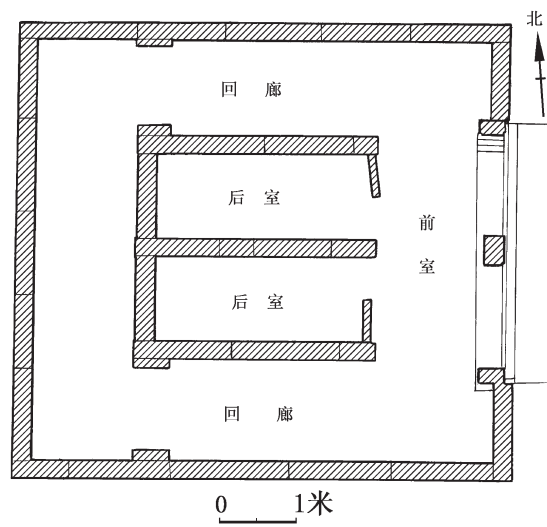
河南省南阳市杨官寺汉墓平面图 (1/100)
